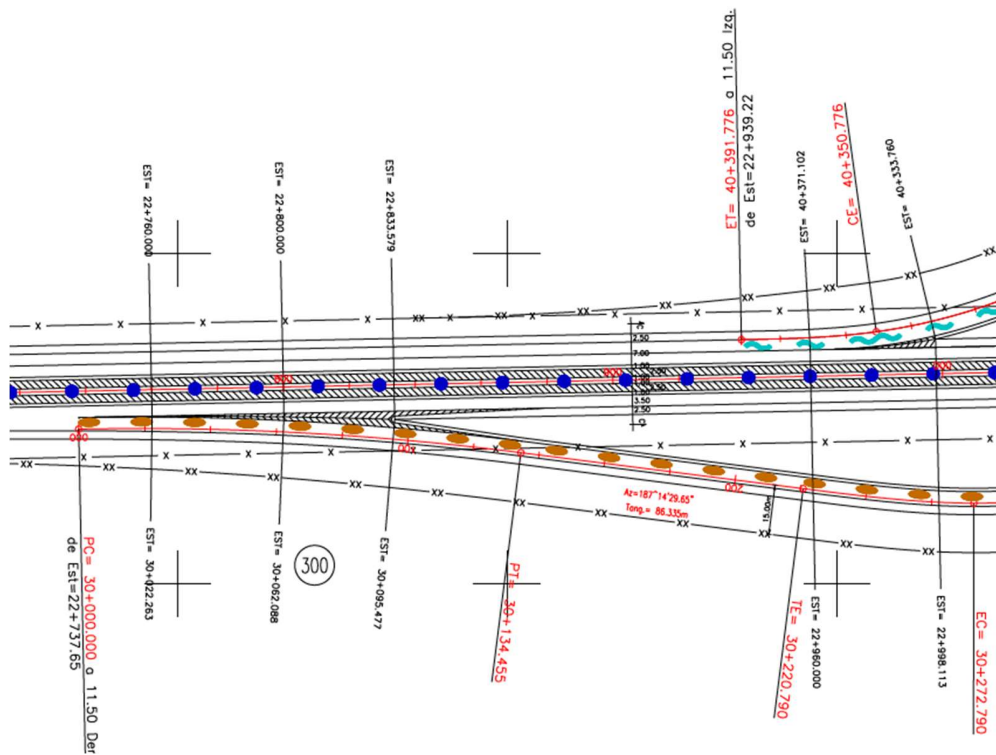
Ejemplo de Ligas (Cadenamientos color negro) en una Planta Constructiva
